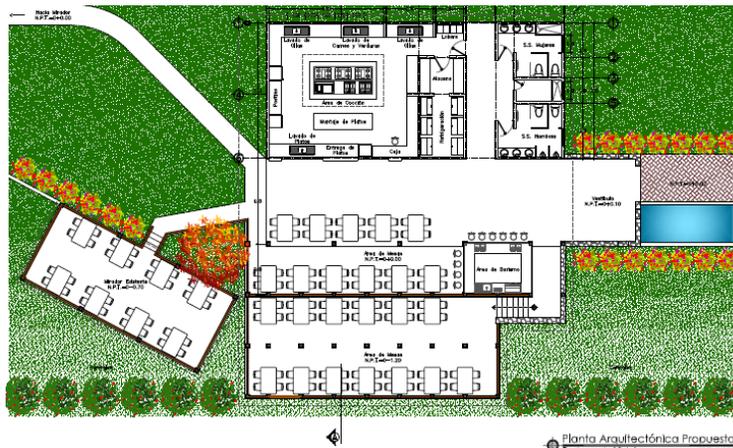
Planta Arquitectónica Restaurante Vista Lago
